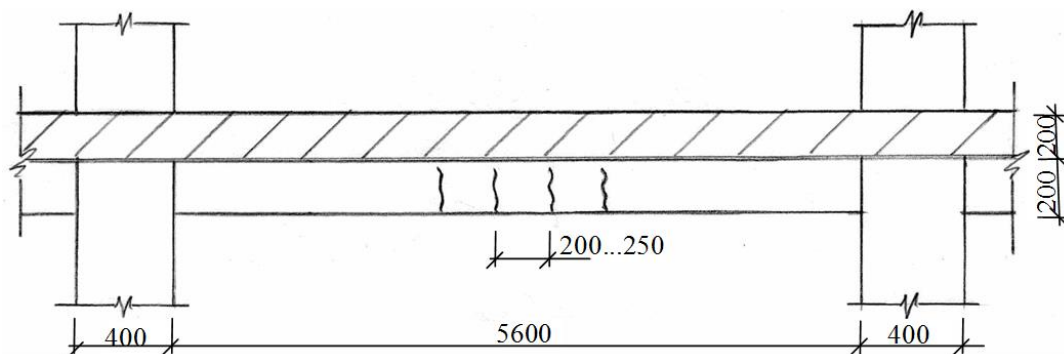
Схема расположения усадочных трещин в балке монолитного перекрытия
